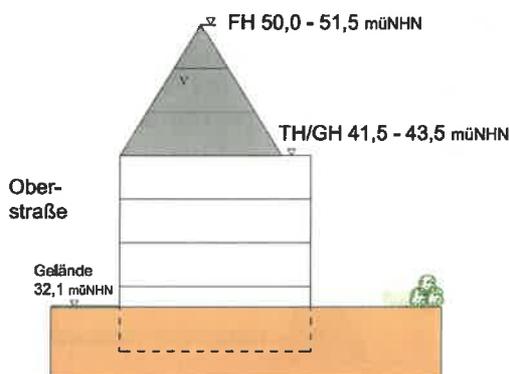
Schemaskizze – Schnitt Bebauung Oberstraße – WA 5 (ohne Maßstab)
